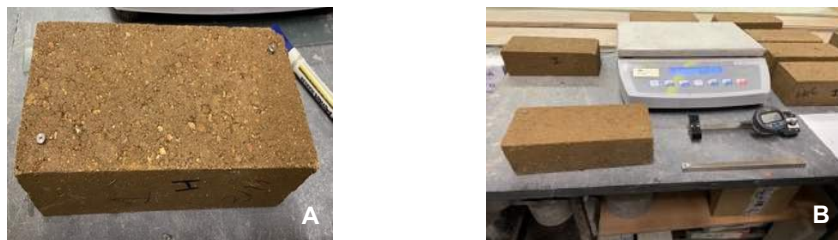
Ensaio de retracção - A) bloco com pastilhas metálicas; B) equipamento utilizado
